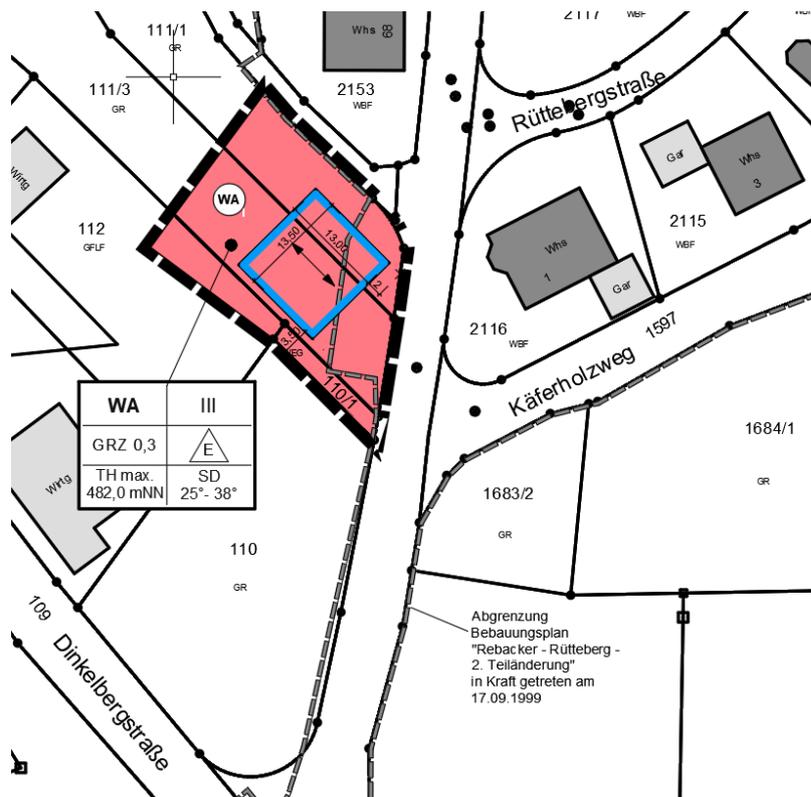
Bebauungsplan Rebacker-Rütteberg mit Stand Nov. 2020 (Quelle: Stadtbau Lörrach)
